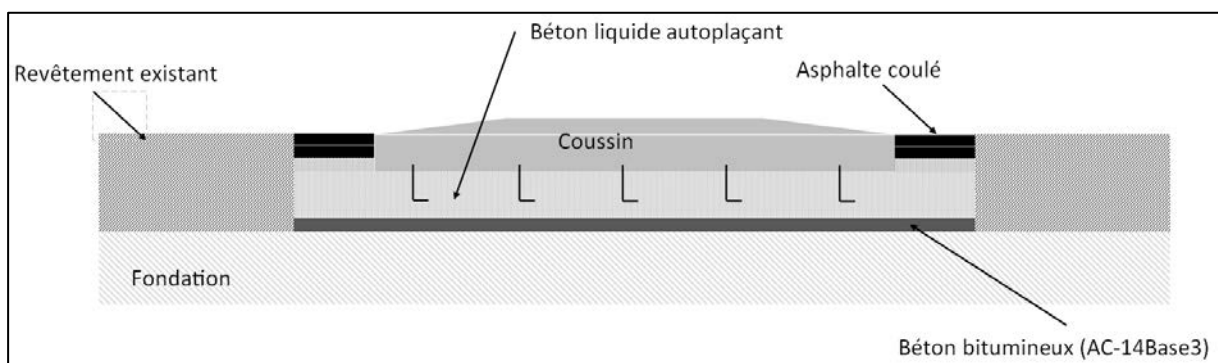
Illustration schématique de la pose d'un coussin sur une fondation en béton autoplaçant et de son resserrage par de l'asphalte coulé posé sur le béton autoplaçant
